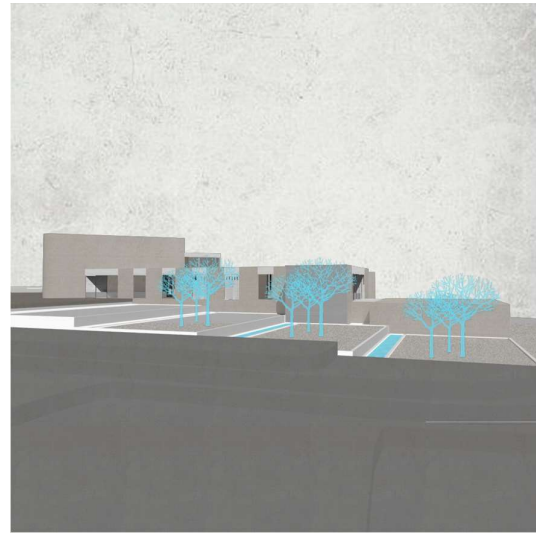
Proyecto final: cortes. Elaboración propia.
